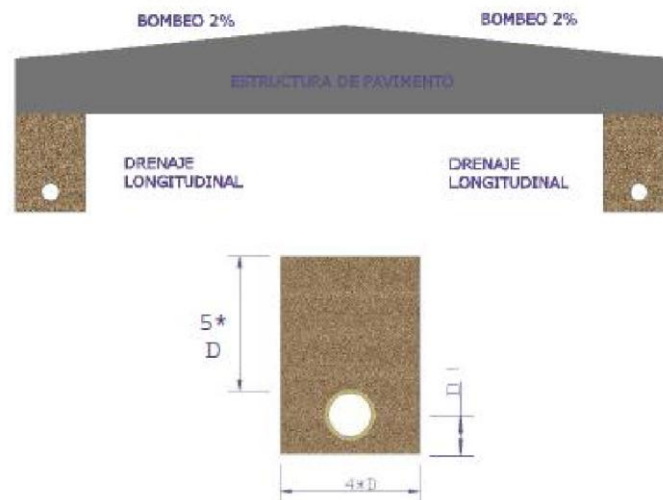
DISEÑO DE ESTRUCTURA DE PAVIMENTO
